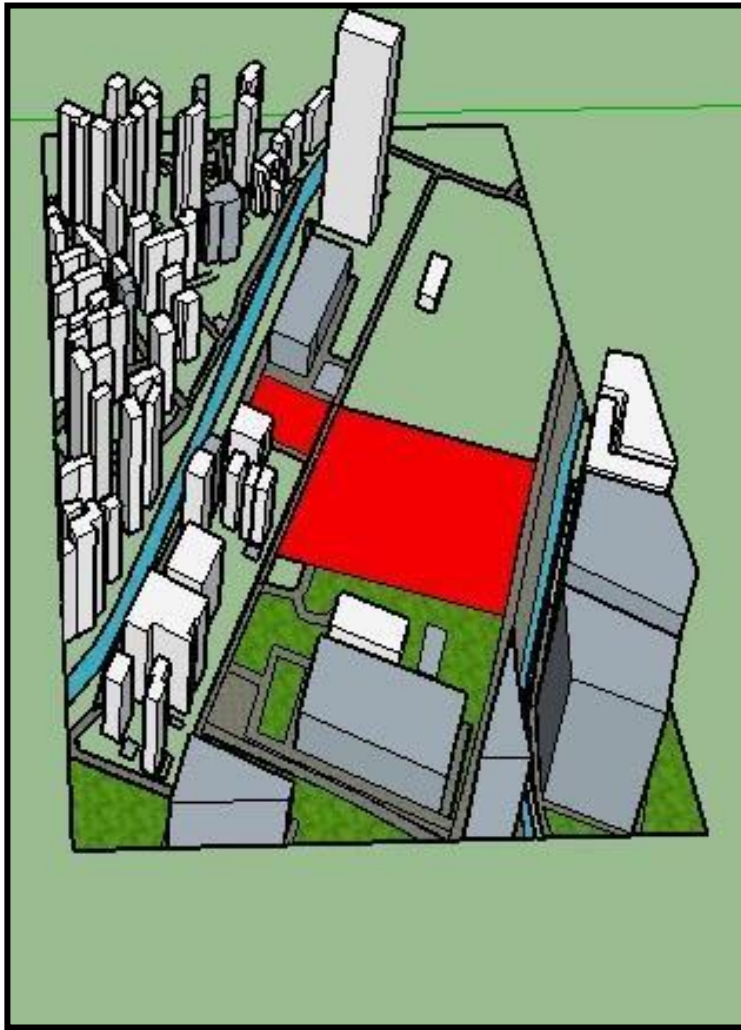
le site d'intervention en 3D, source : auteur ,2024
